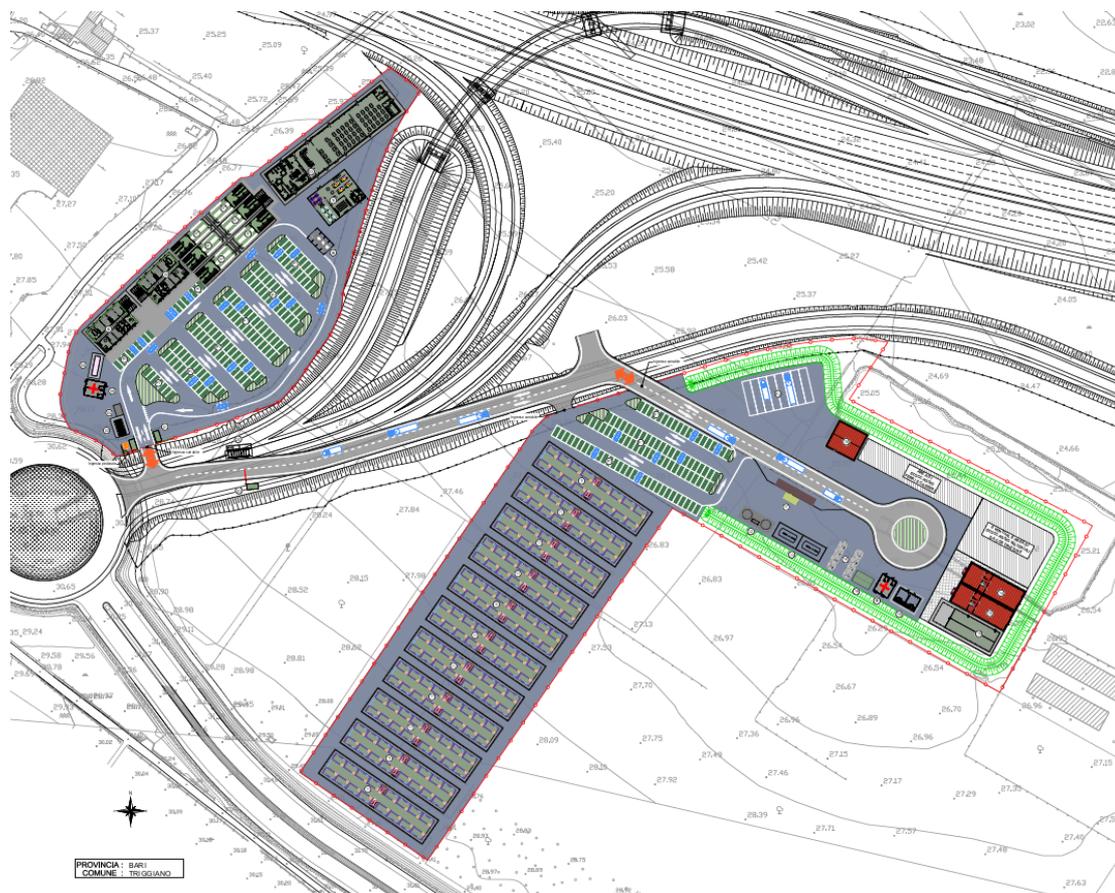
planimetria layout di cantiere CB01-a e CB01-b
